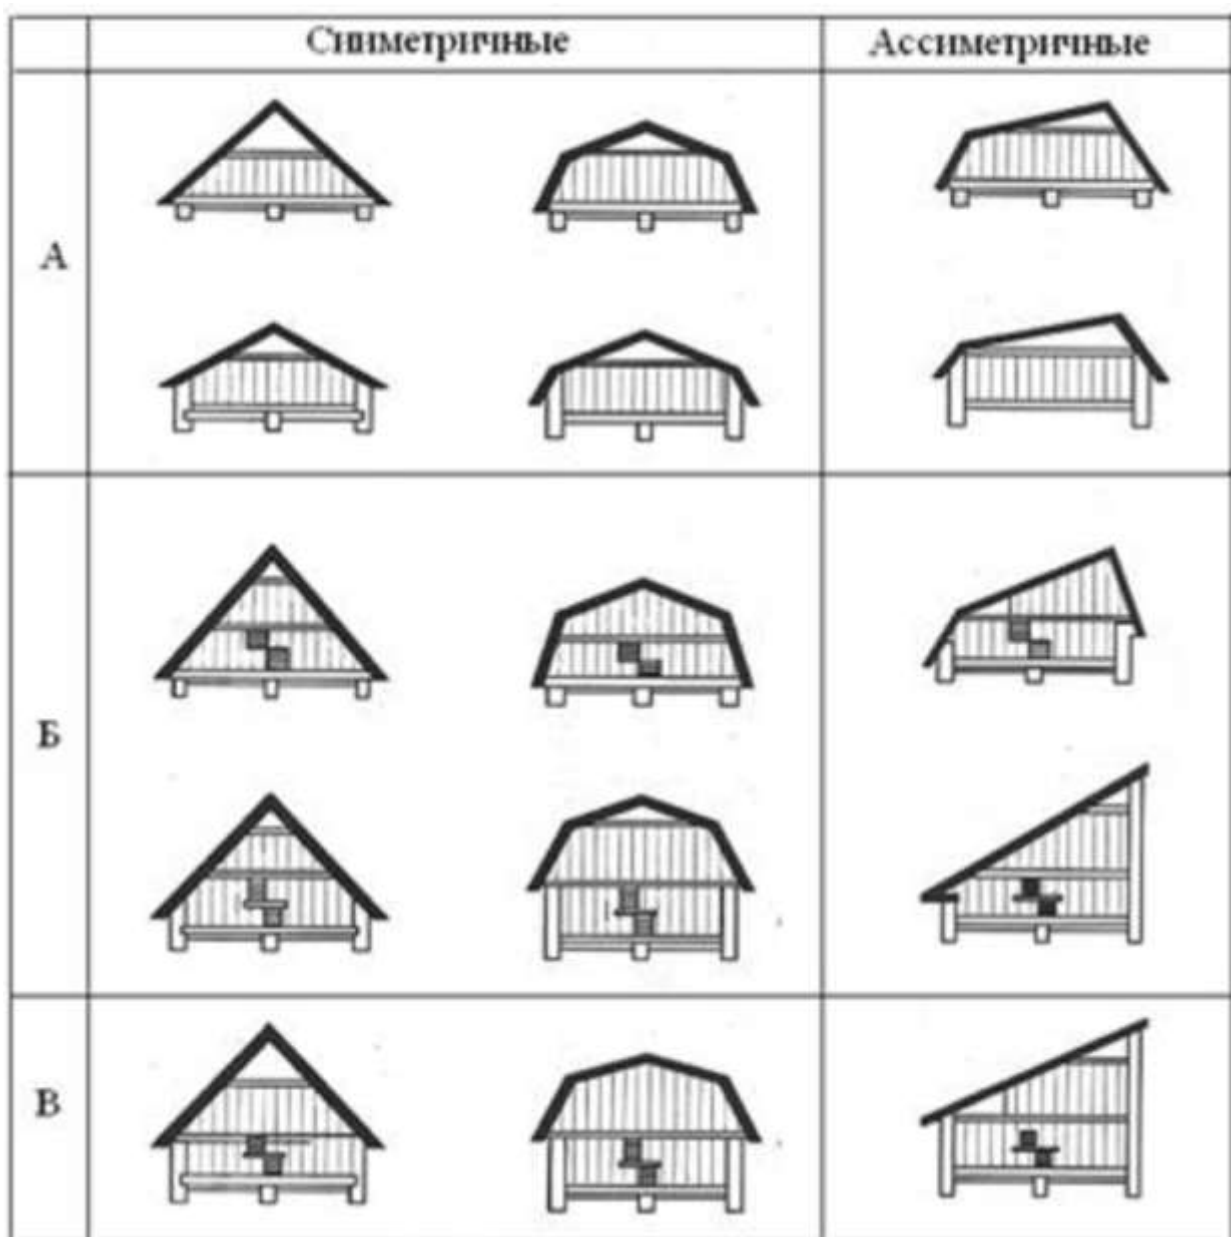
Типы мансардных этажей по видам кровли и уровням
